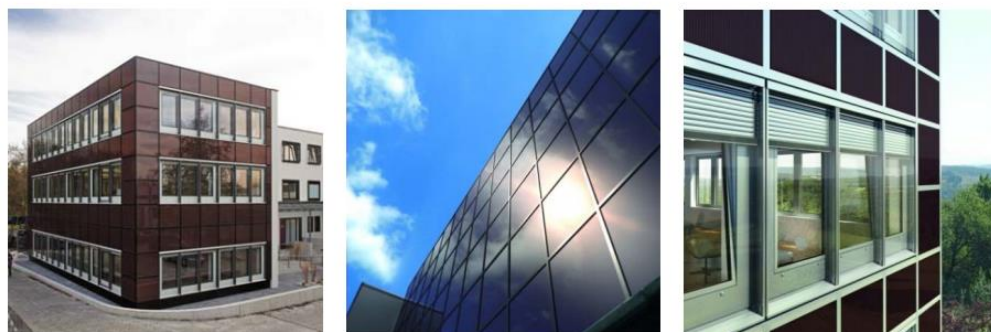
Módulos integrados nas fachadas em substituição aos vidros ou outras vedações planas opacas.
